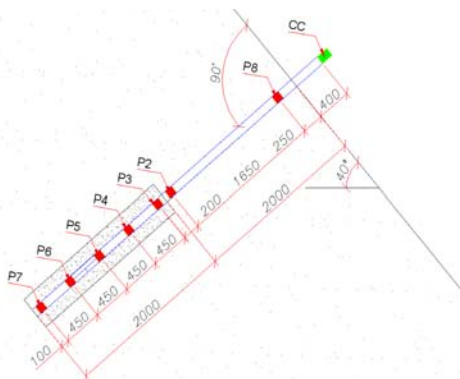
Detalhe- da disposição e nomenclatura das pontes ao longo das barras
